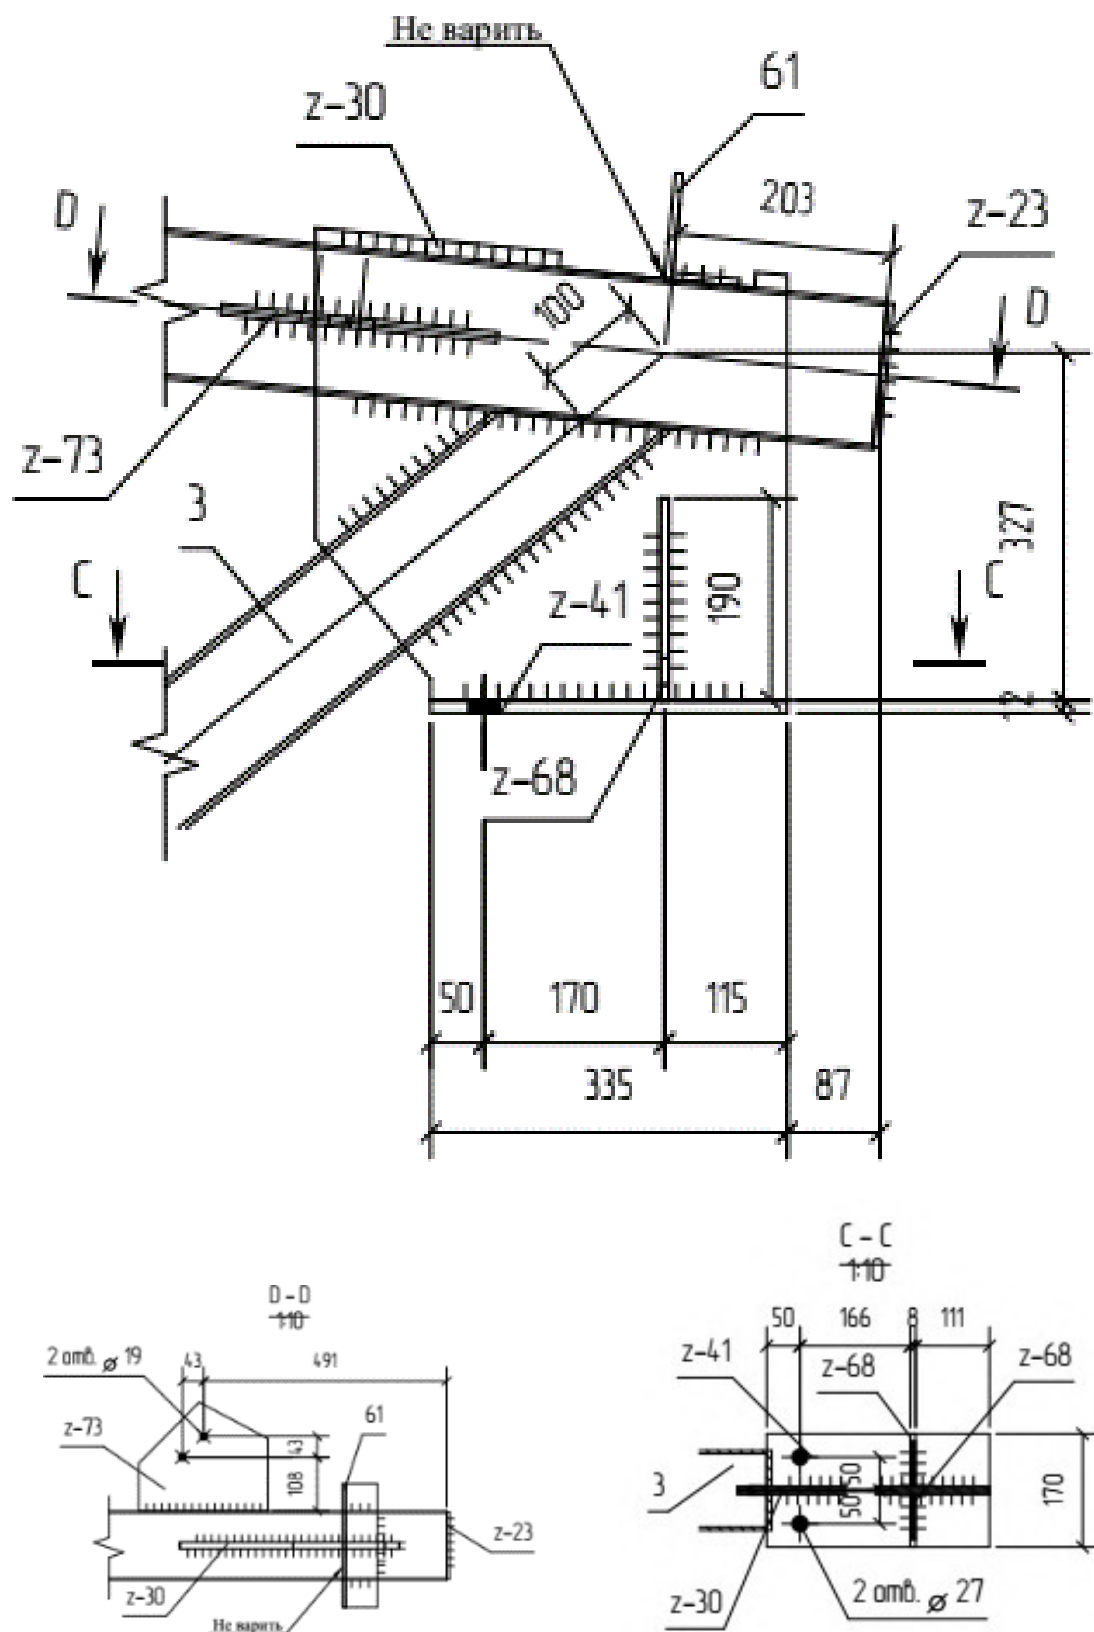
Опорне з'єднання нижнього поясу ферми з верхнім поясом
